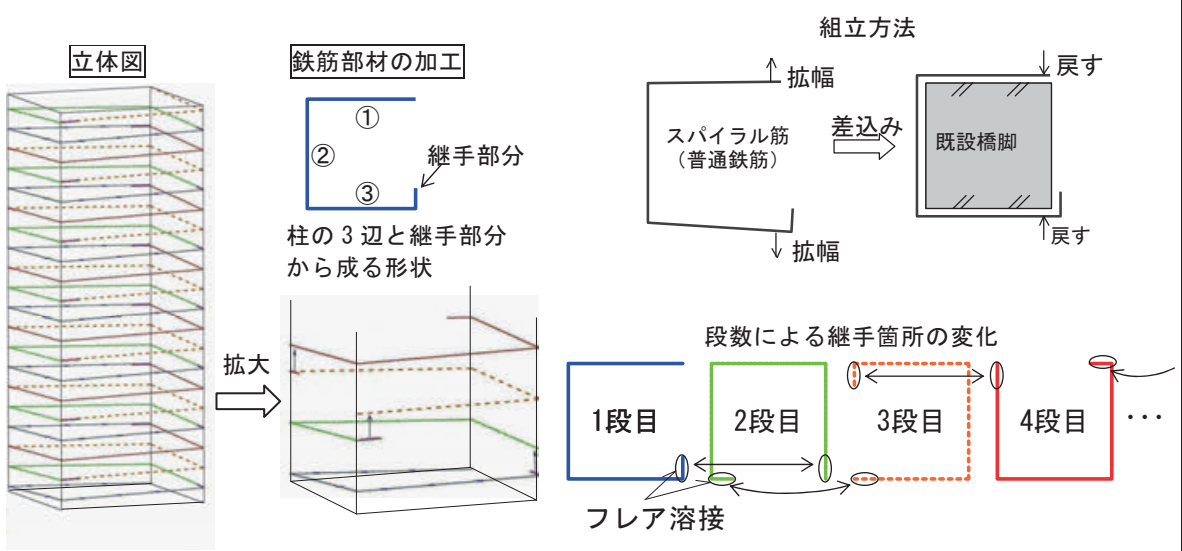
普通鉄筋スパイラル巻立工法概略説明図
